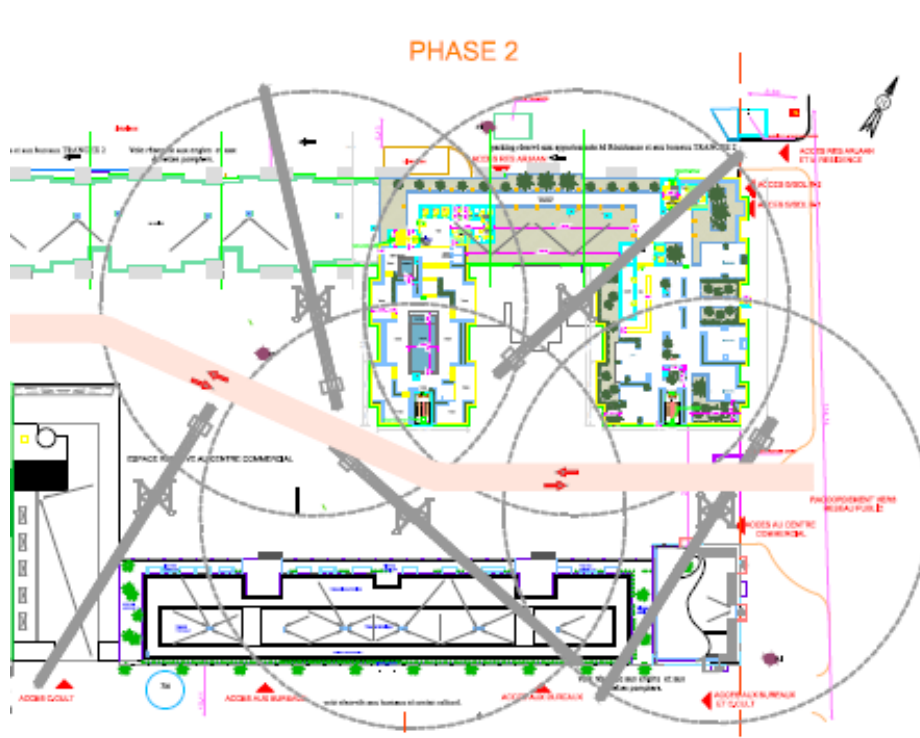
PLAN D'INSTALLATION CHANTIER POUR LA T2 ET T3
